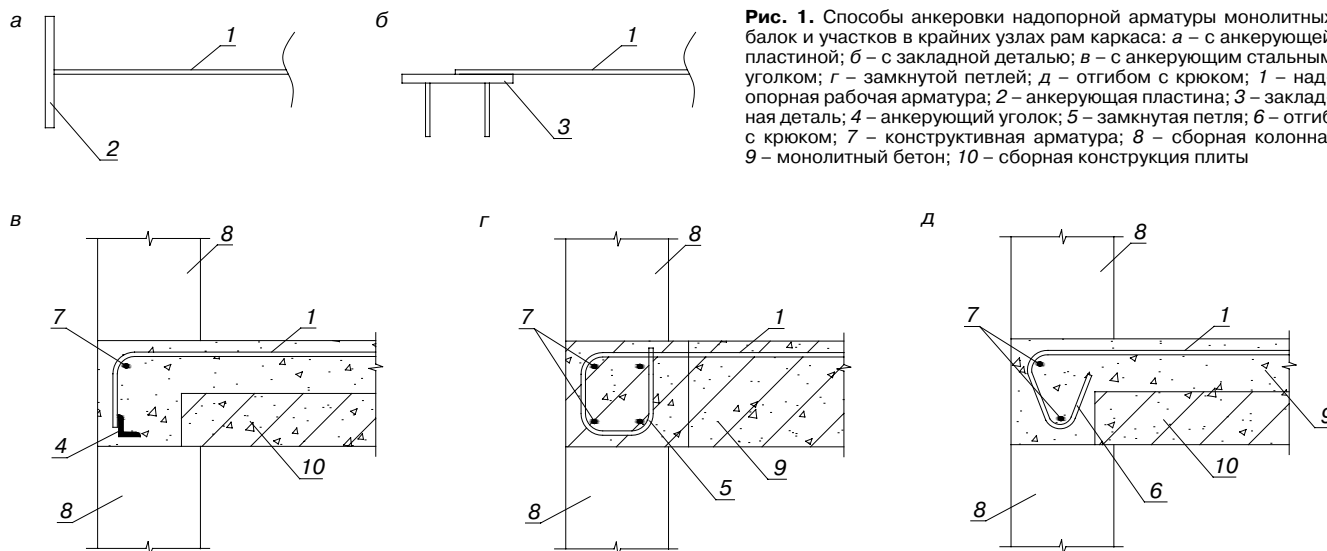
Способы анкерки надопорной арматуры монолитных балок и участков в крайних узлах рам каркаса: а – с анкерующей пластиной; б – с закладной деталью; в – с анкерующим стальным уголком; г – замкнутой петлей; д – отгибом с крюком; 1 – надопорная рабочая арматура; 2 – анкерующая пластина; 3 – закладная деталь; 4 – анкерующий уголок; 5 – замкнутая петля; 6 – отгиб с крюком; 7 – конструктивная арматура; 8 – сборная колонна; 9 – монолитный бетон; 10 – сборная конструкция плиты
